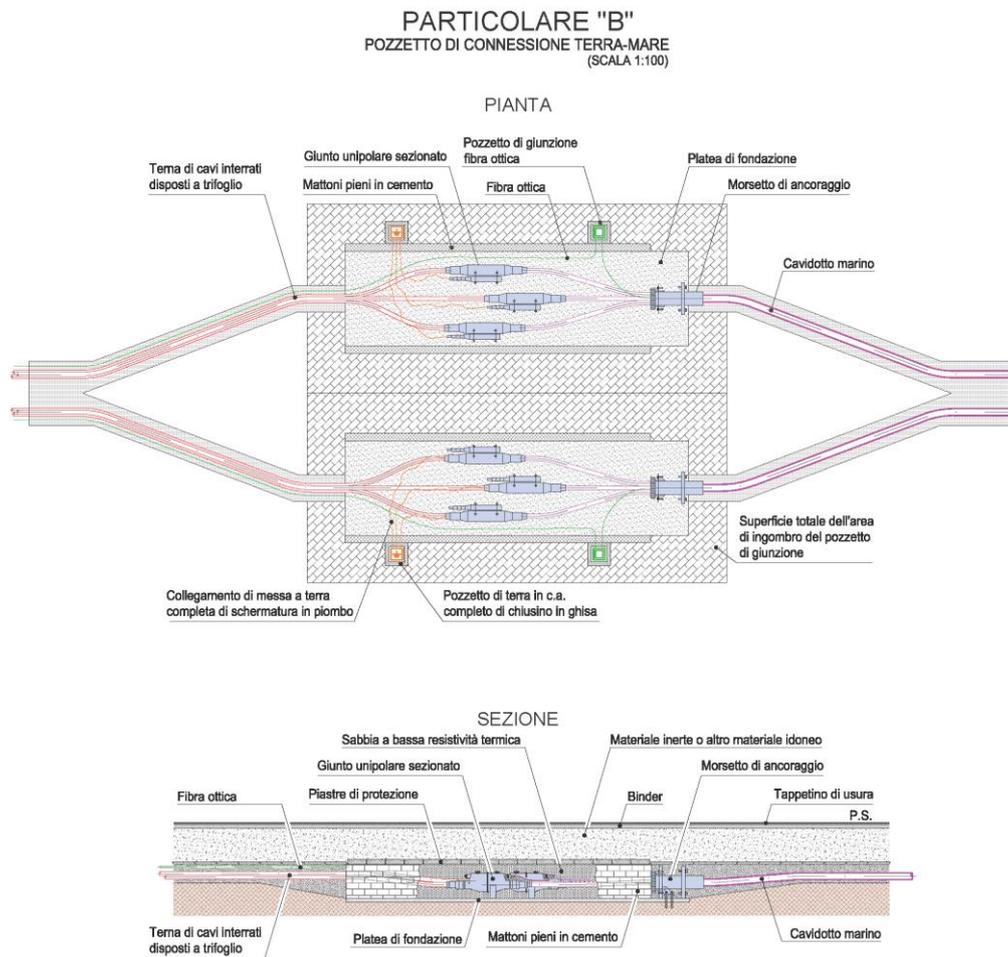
Pianta e sezione tipo del pozzetto di giunzione mare/terra (stralcio da Tavola F0122.TT09.AREDEM.00).
